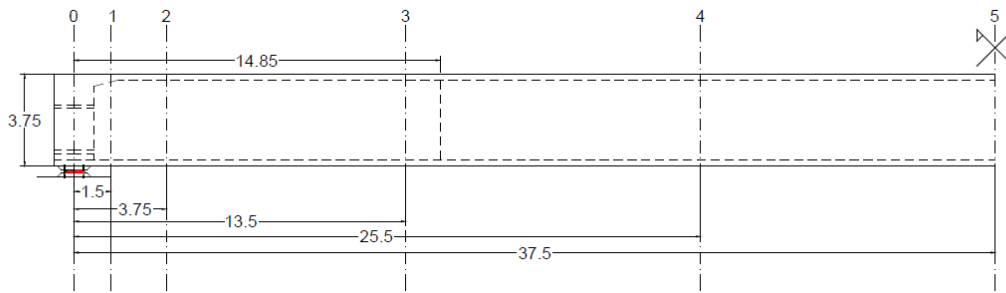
Perfil longitudinal tabuleiro do caso de estudo (H = 3.75 m) [Dimensões em m]
